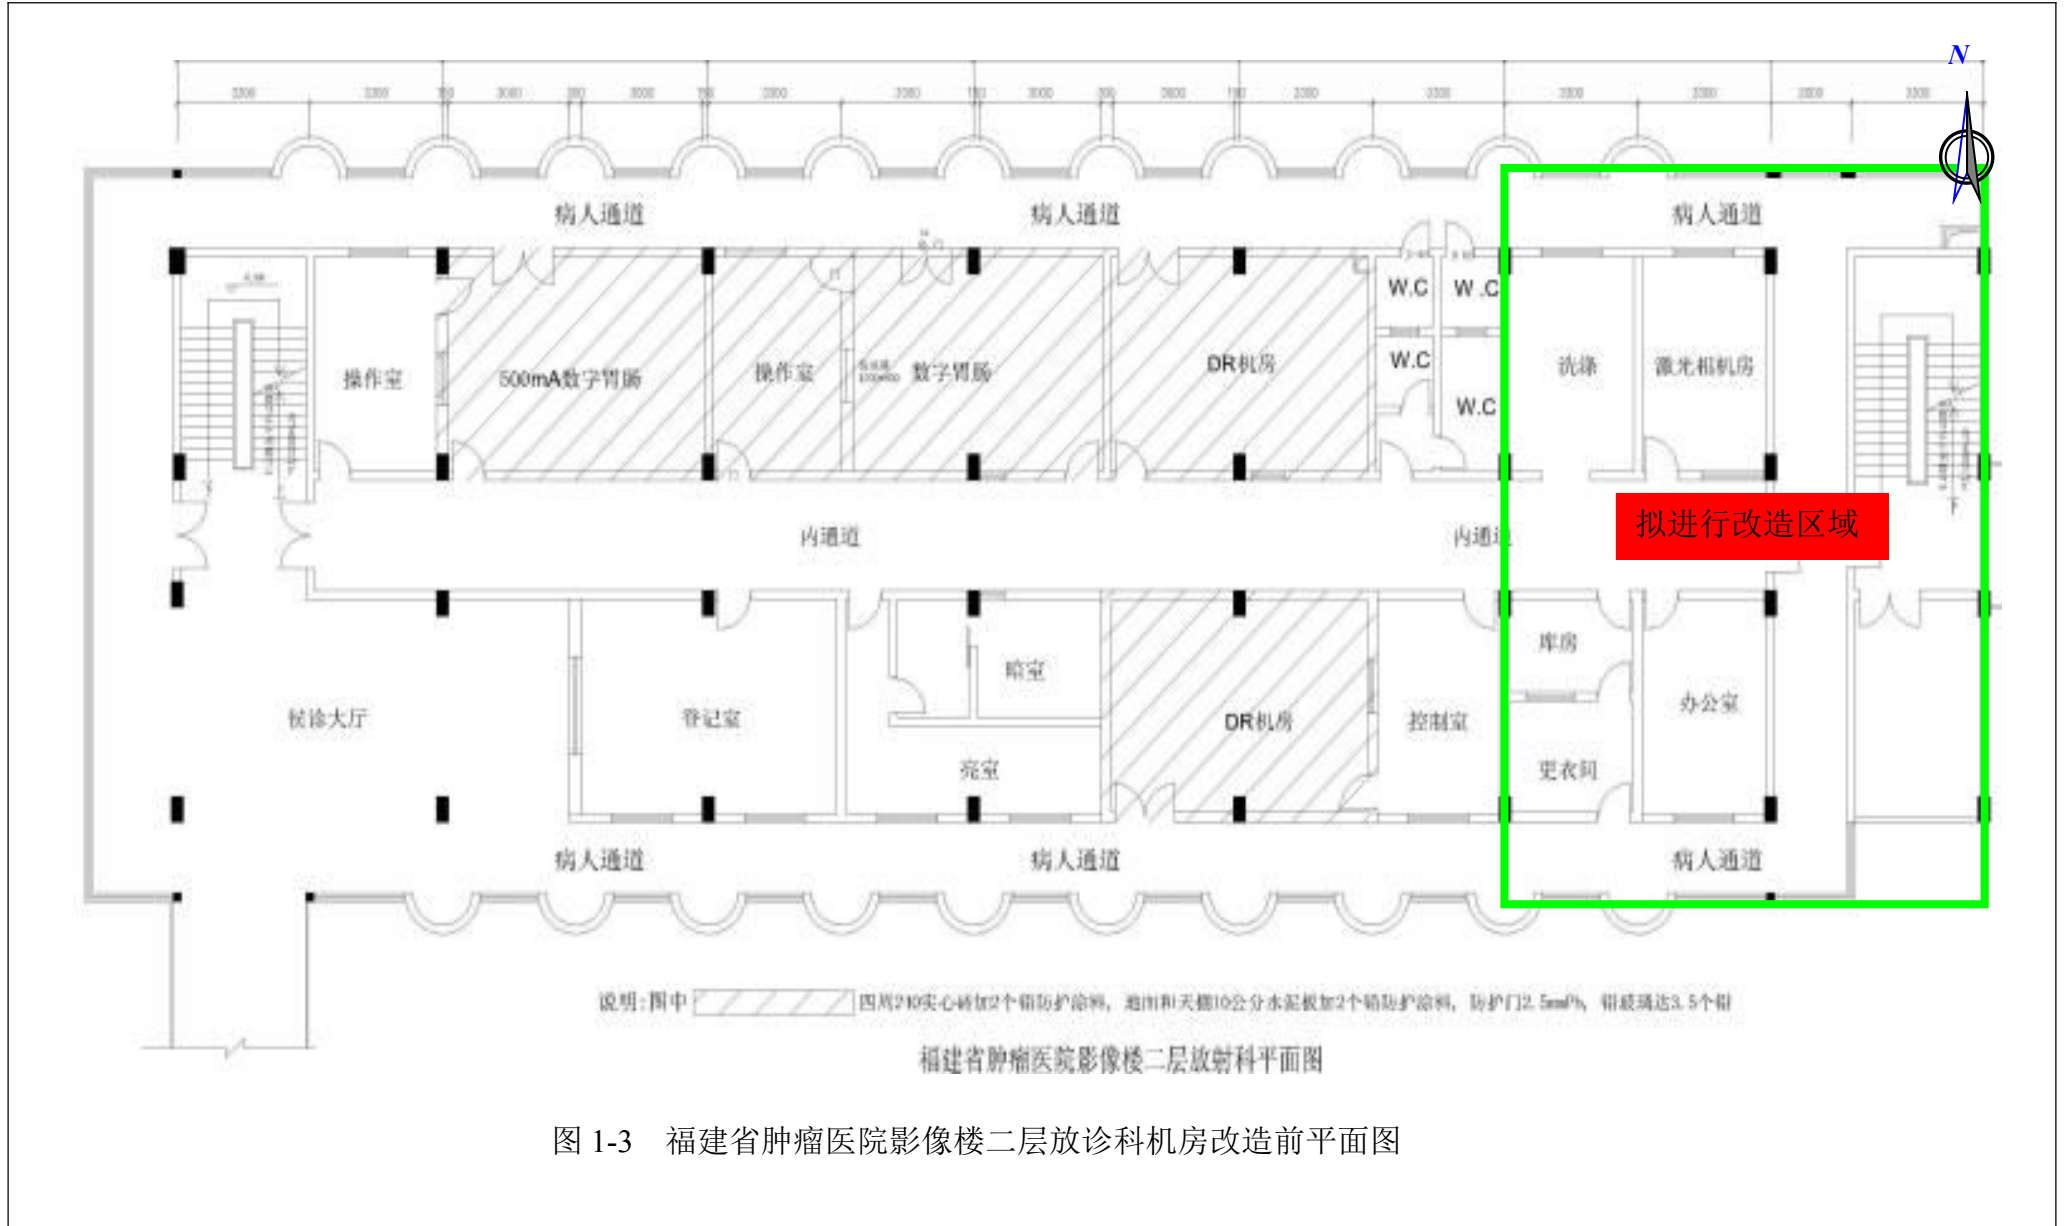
福建省肿瘤医院影像楼二层放诊科机房改造前平面图
